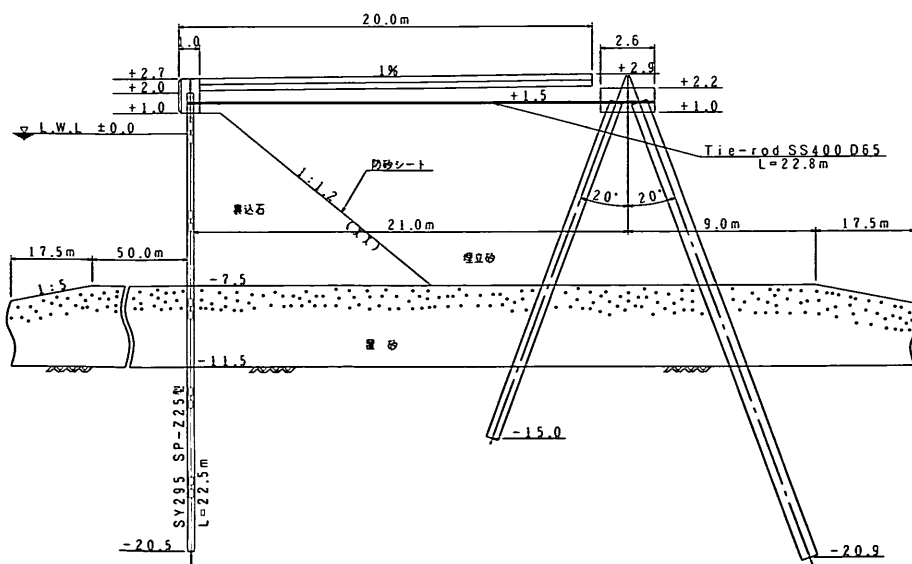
漁港地区南側-7.5m岸壁標準断面図
